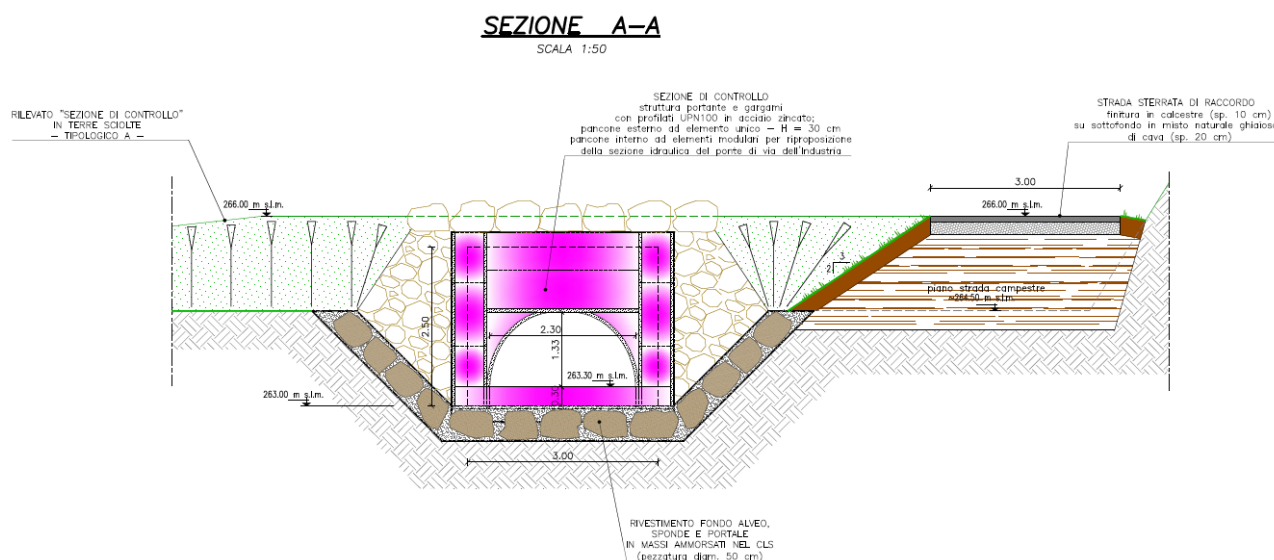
Vista d'insieme (Progetto Definitivo Lotto 2)
